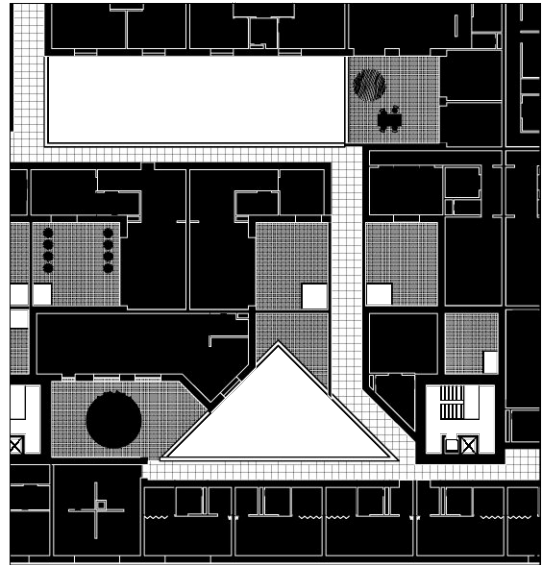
Grundriss Ausschnitt Via dei Lucani; Wohngeschoss und Einschnitte
